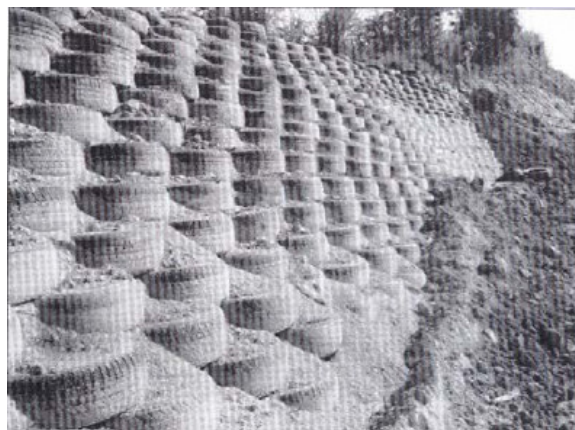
Proteção Direta – Sistema Eco-Estrutural Pneumático – Muro de
